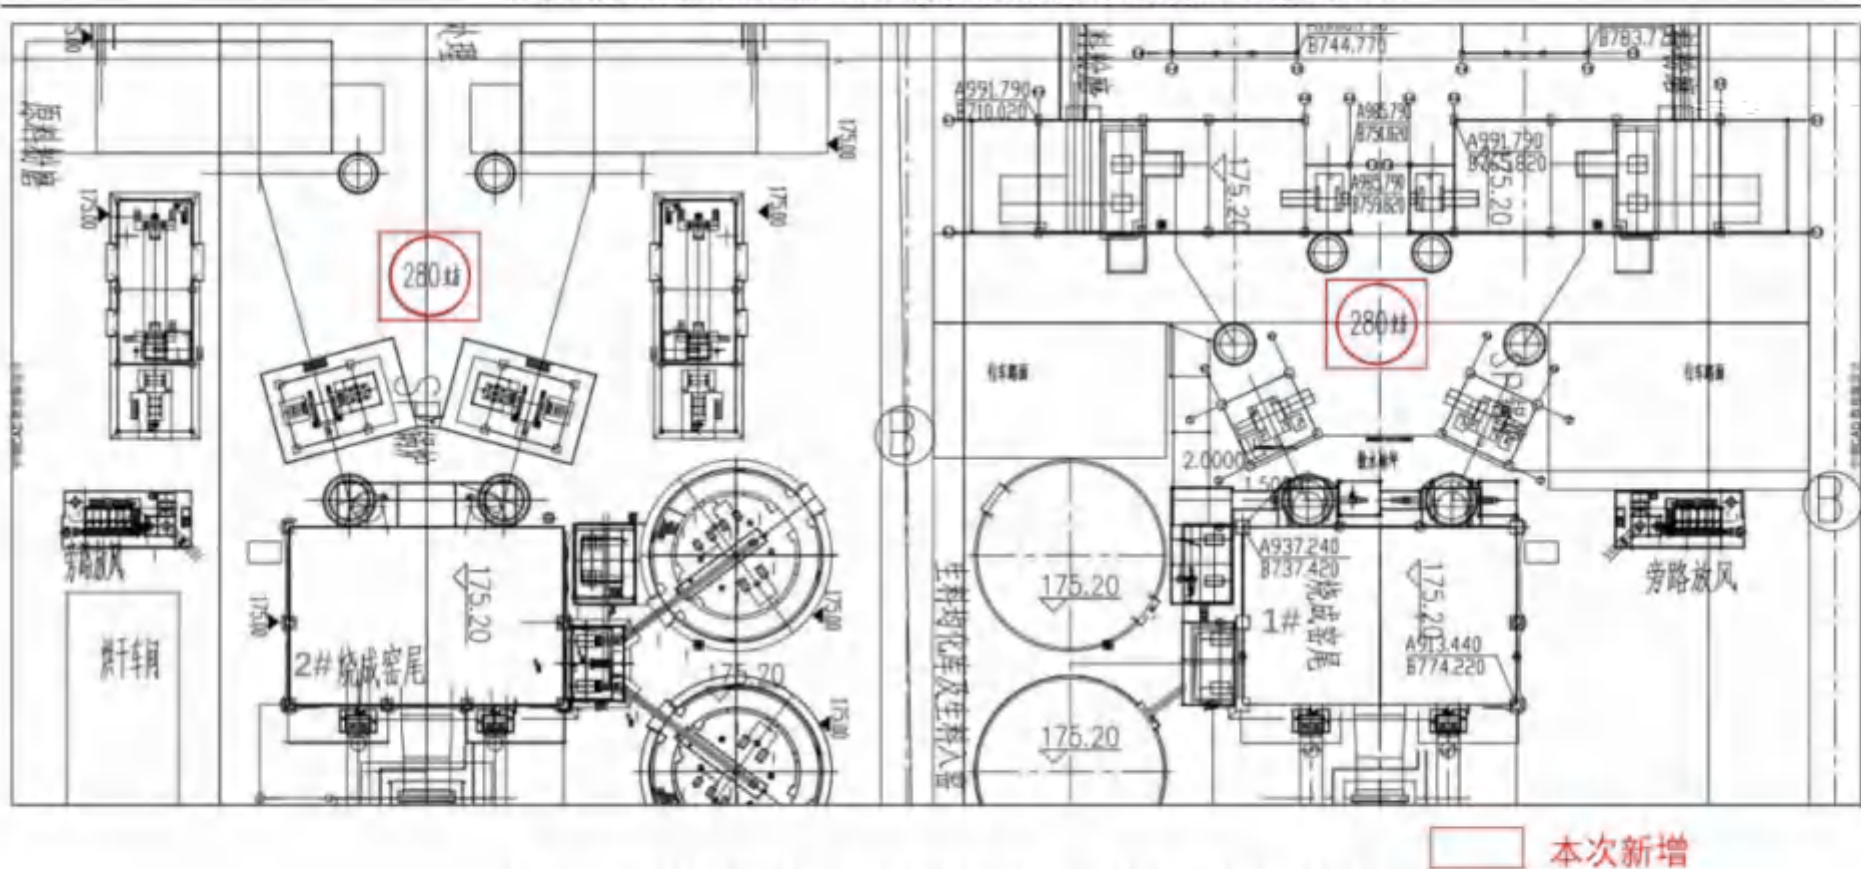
技改项目新增铝灰渣储罐（7、8#料仓）平面布置图
